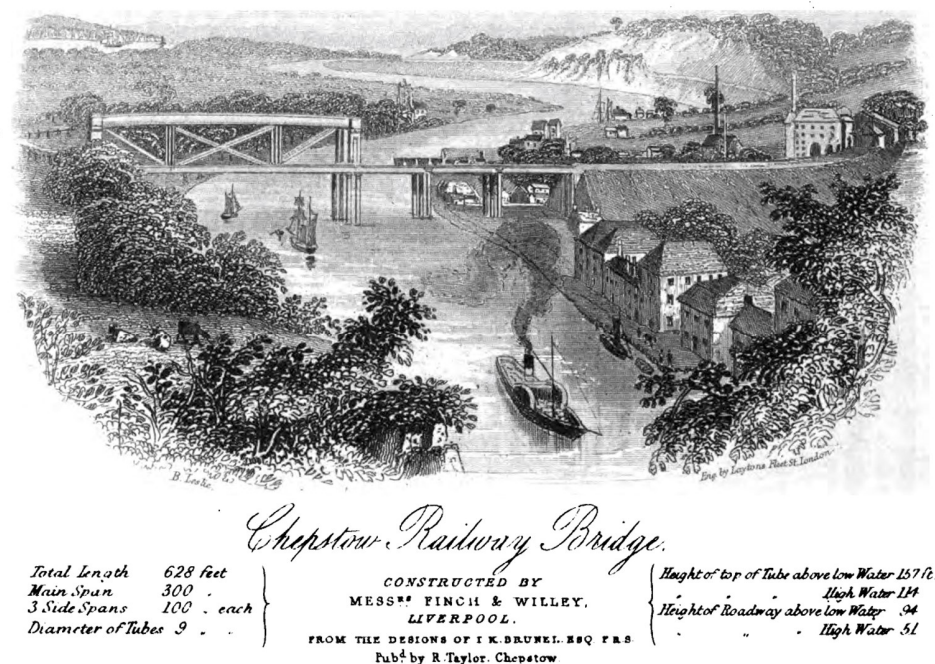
Railway Tubular Suspension Bridge von Isambard Kingdom Brunel, 1852
